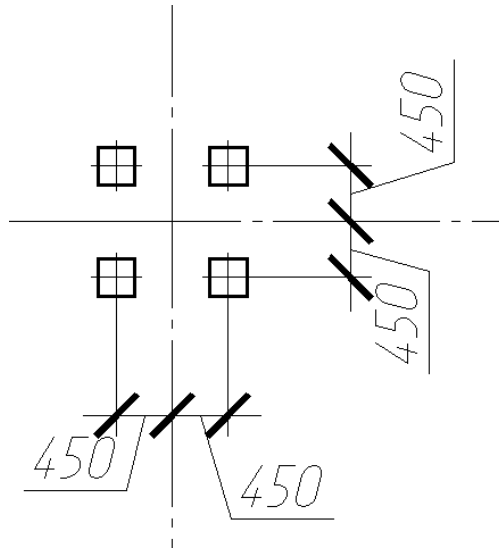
Фрагмент расположения свай под колонну каркаса
